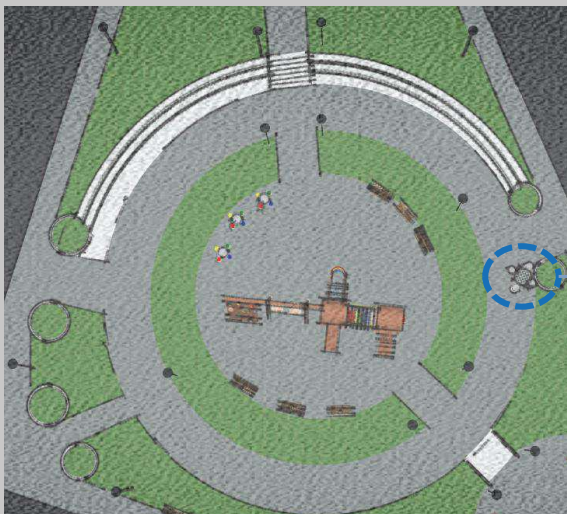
Croqui do Platô 02 da Praça Sebastião Ananias Silva
